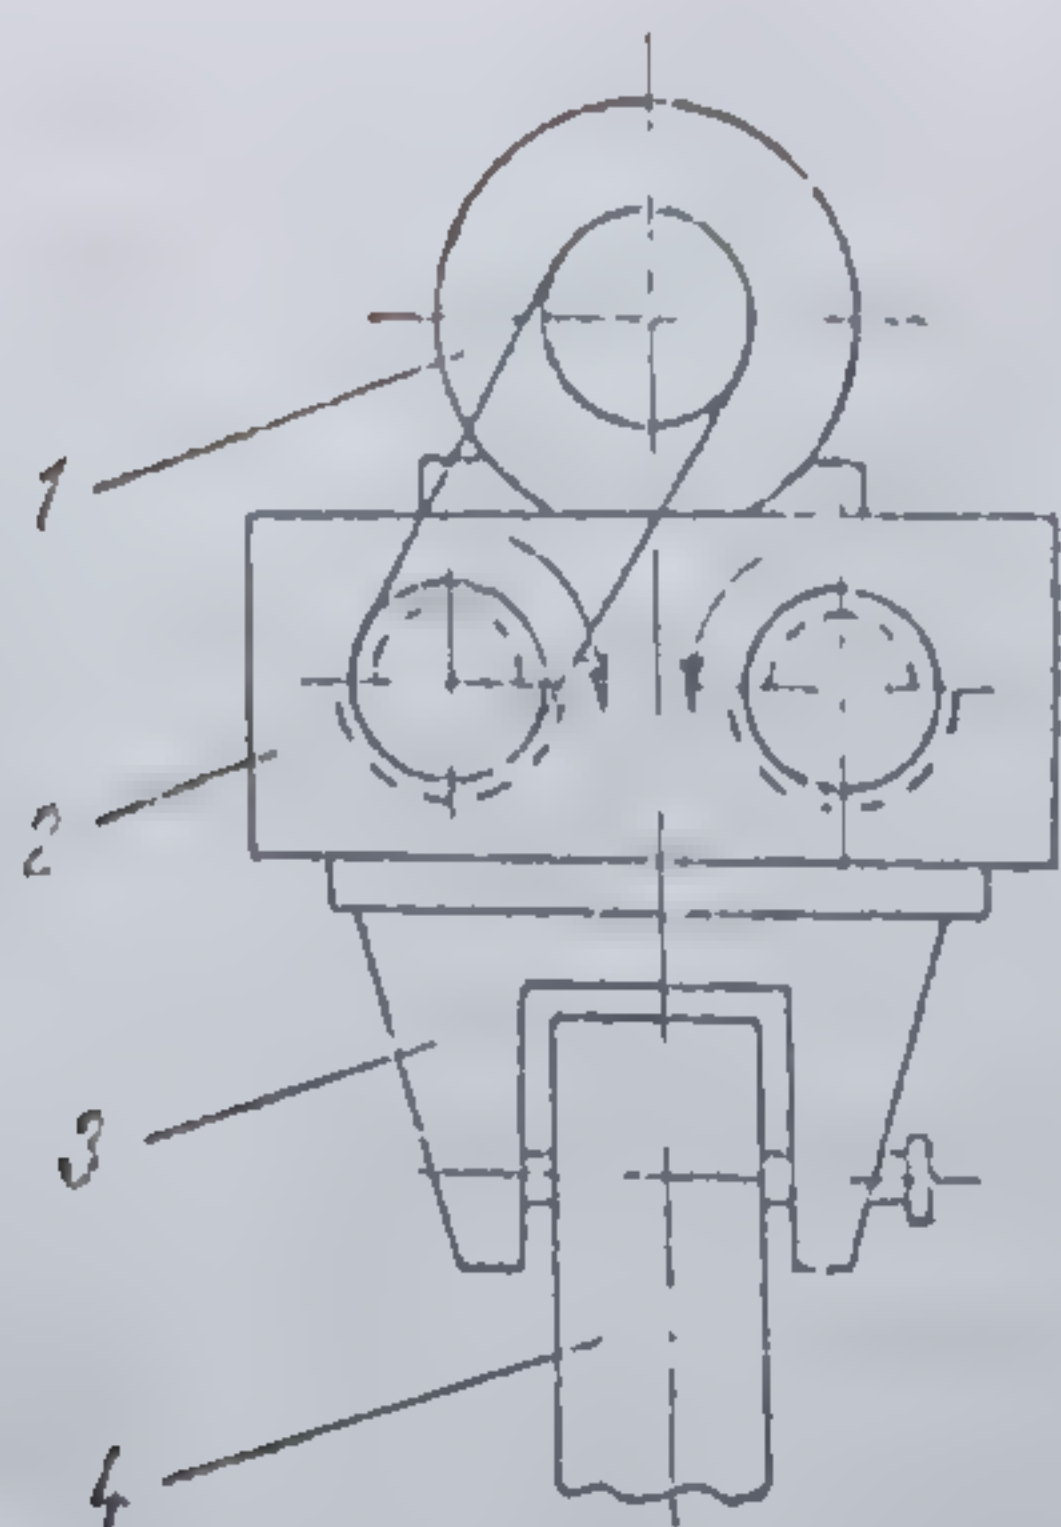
Vibrator cu excentrice, cu prindere rigidă a motorului.
